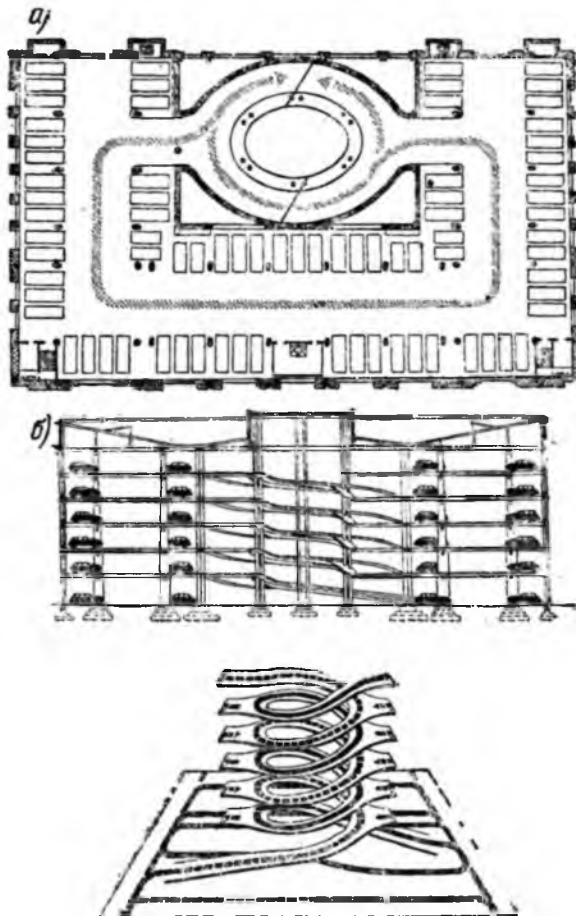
Схема решения многоэтажного гаража: а — план верхнего этажа; б — продольный разрез; в — схема ramпы-пандуса
